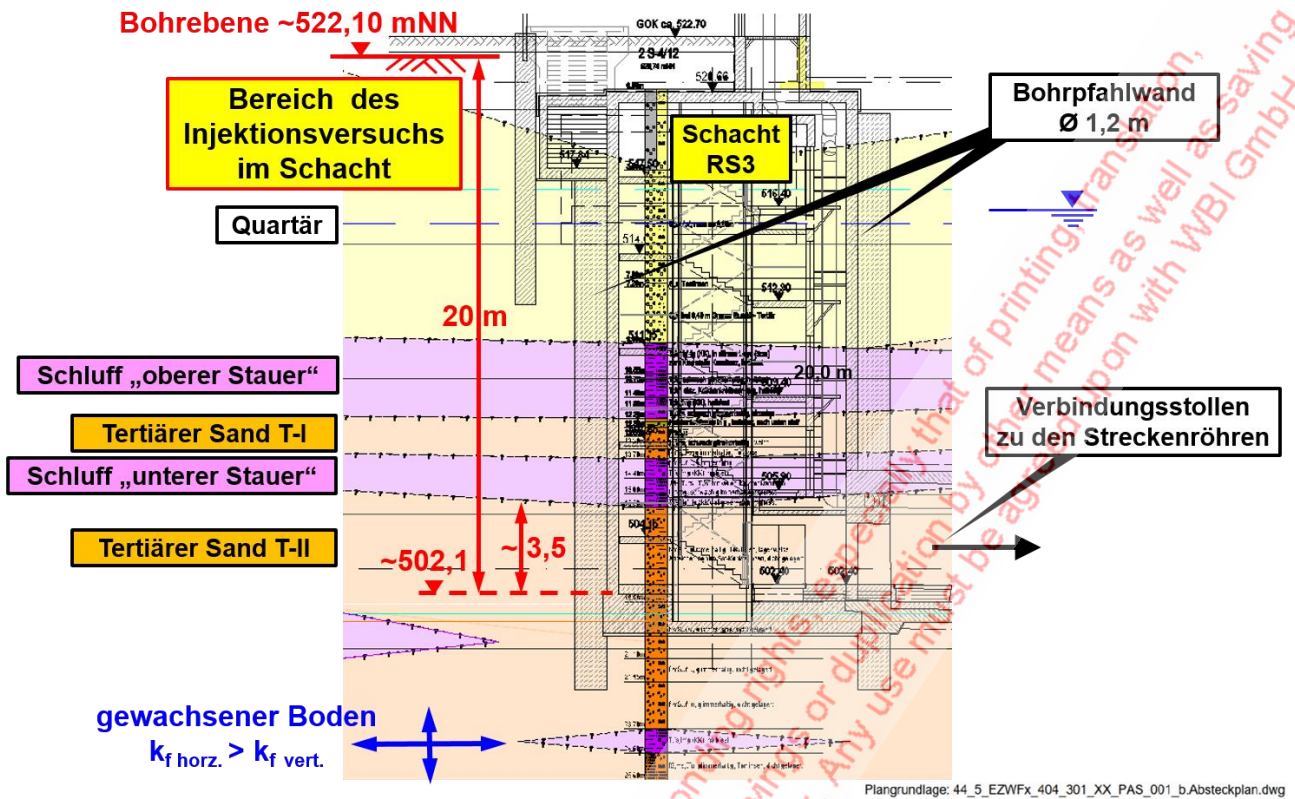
Vertikalschnitt mit Untergrundaufbau Rettungsschacht 3
